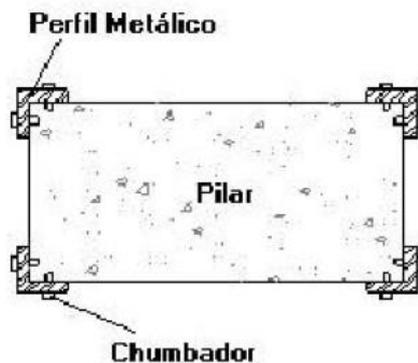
Esquema mostrando o reforço com utilização de cantoneiras em pilares (FONTE: SILVA, 2007)
